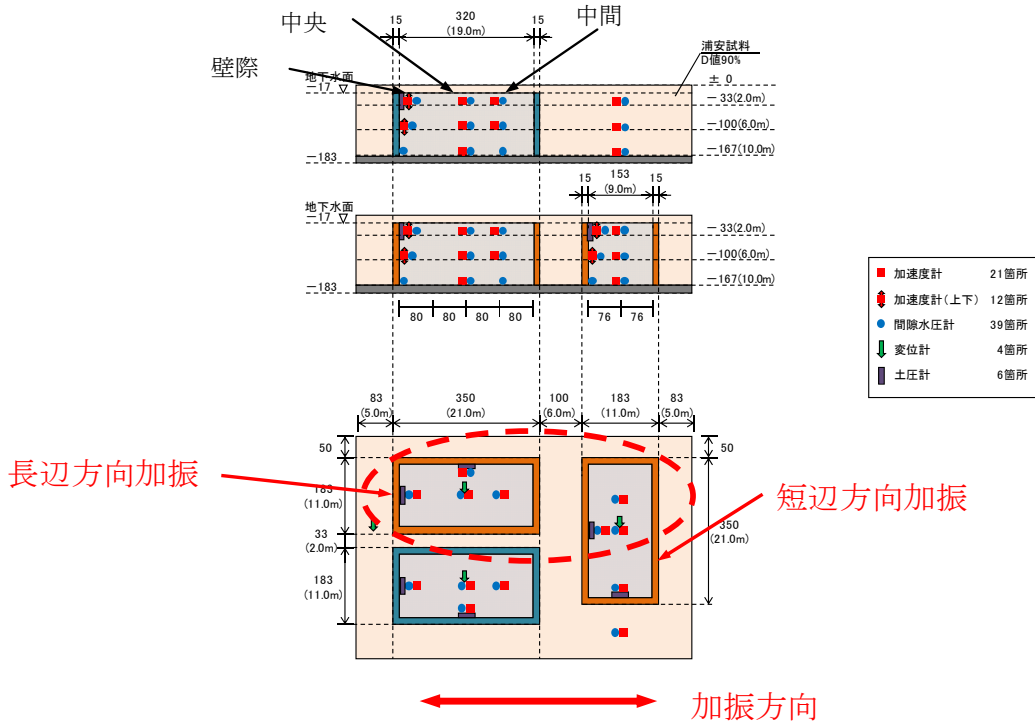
計測器の配置図(上：断面図、下：平面図)
